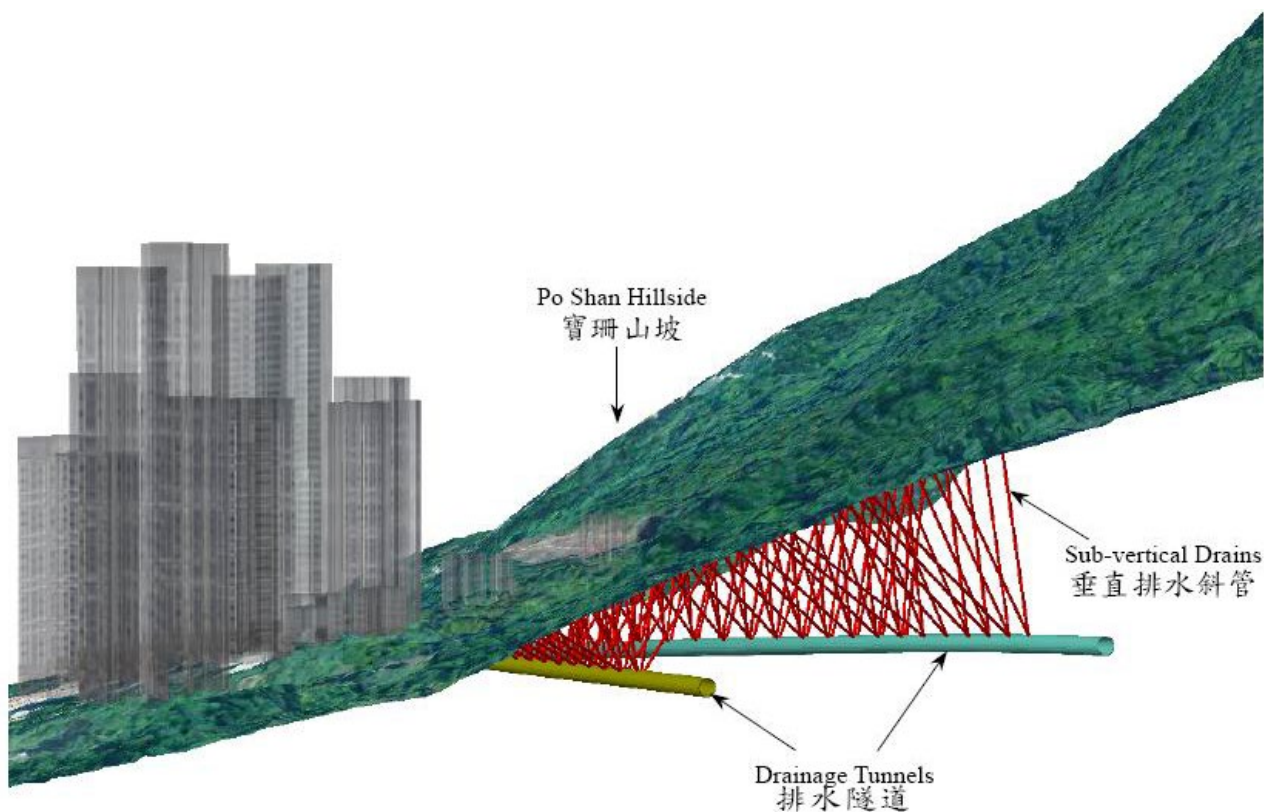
Foto rendering dei tunnel drenanti scavati all'interno del versante. Da notare la disposizione sub vertical dei dreni. Rendering by CEDD Geotechnical Engineering Office Civil Engineering and Development Department of Hong Kong.
